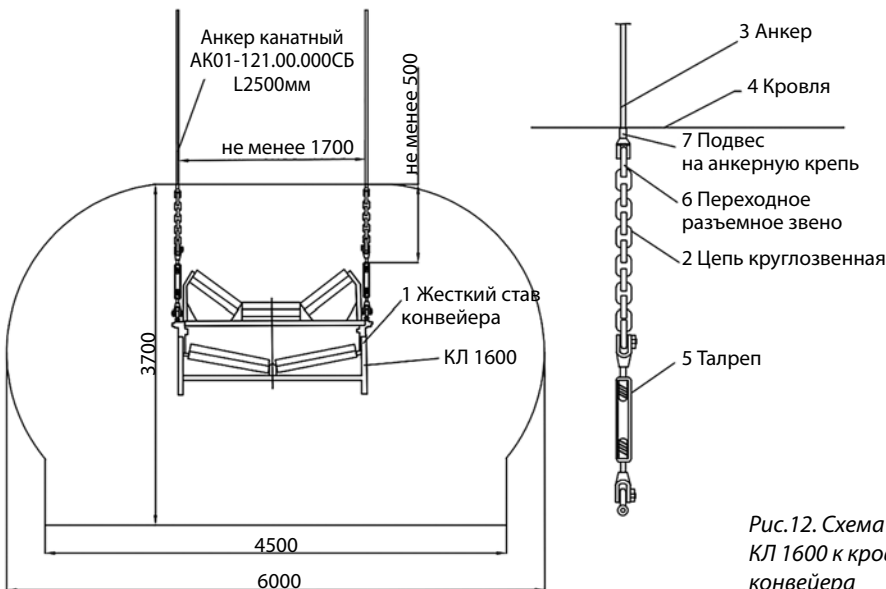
Схема подвешивания ленточного конвейера КЛ 1600 к кровле выработки с элементами подвеса конвейера
